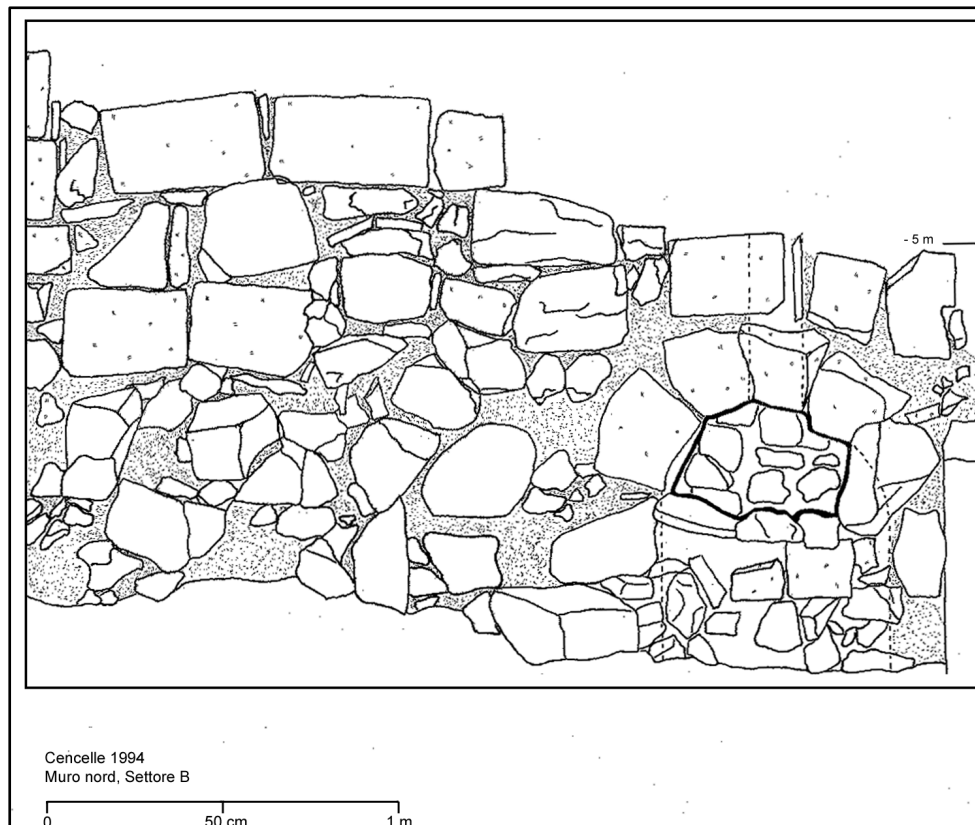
Il prospetto del muro Nord dell'ambiente B disegnato a mano nel corso dello scavo
